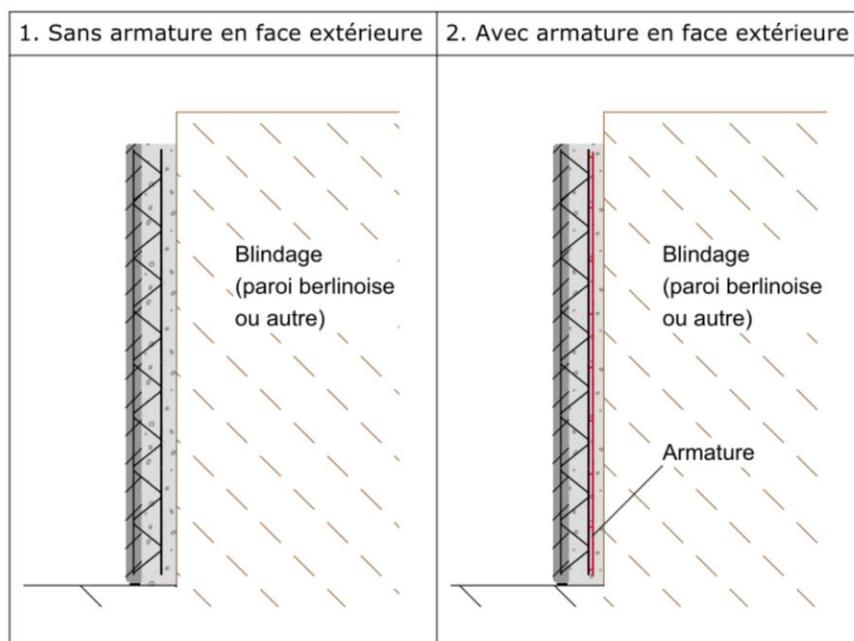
Mur en infrastructure avec ou sans ferrailage en deuxième face
